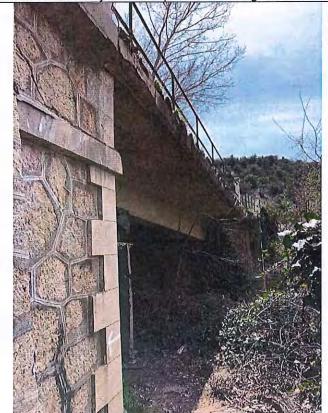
Vista del estribo derecho, y del tablero, desde aguas abajo del río.
